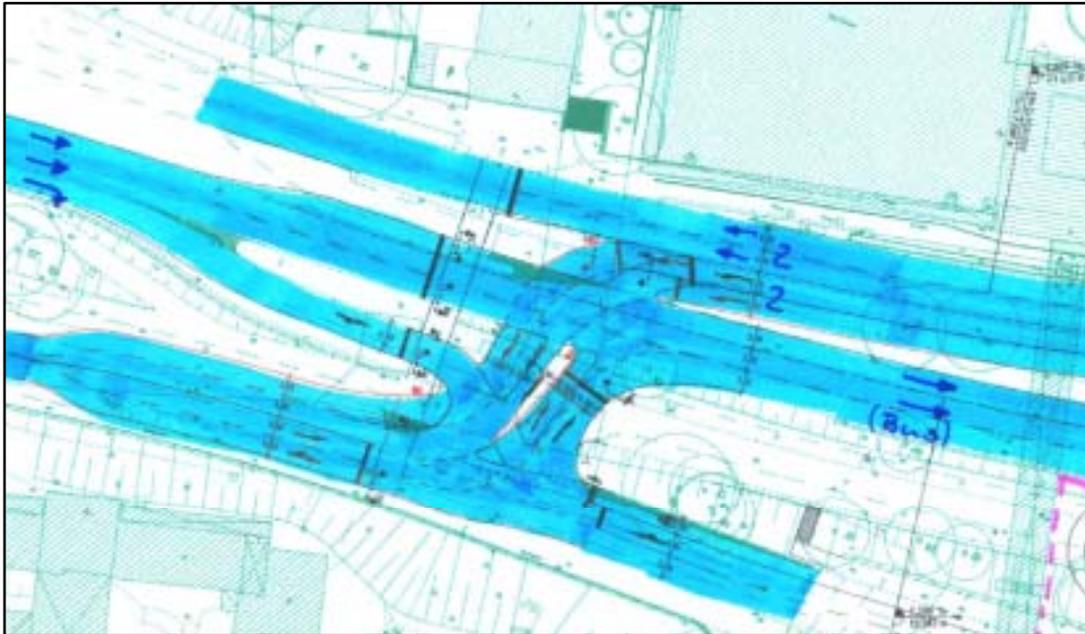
Plandarstellung Vollanschluss Südstraße - Bundesallee
